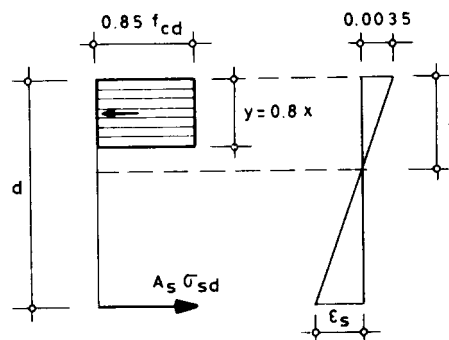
Diagrama rectangular de tensión-deformación del hormigón.
